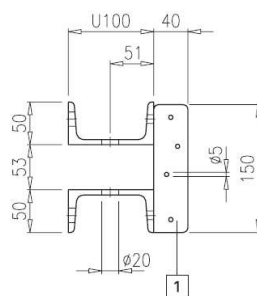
Cinta metálica WS 1 0. (DOKA)
